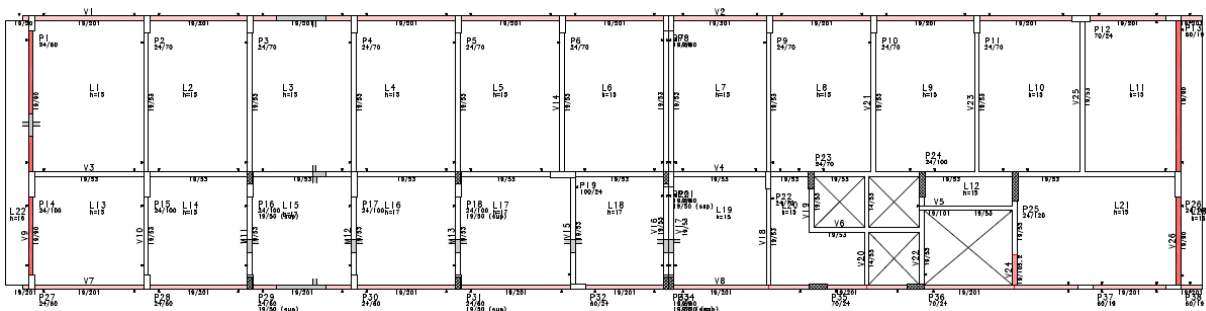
Concepção da cobertura. (Fonte: Autor, 2023)
